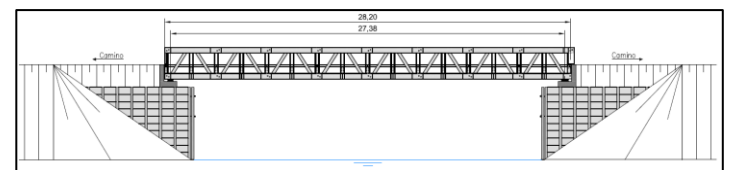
C. Alzado del puente metálico desmontable con 8 módulos.
